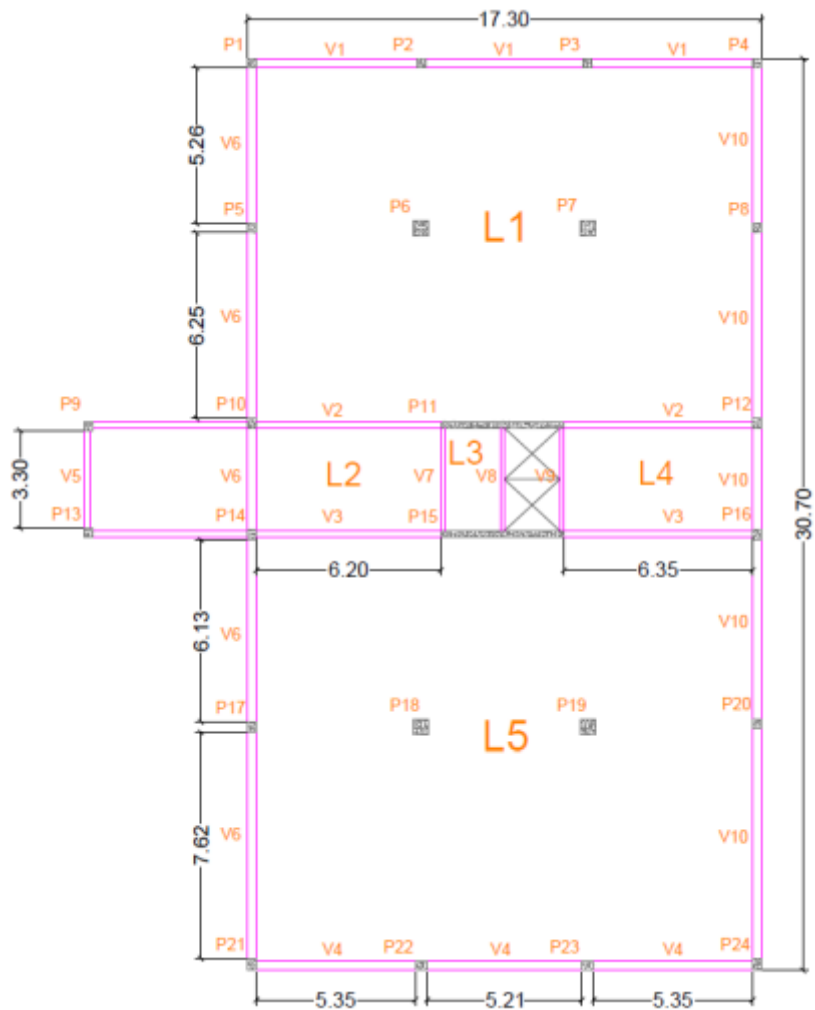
Planta de forma do pavimento tipo. (PAIVA, 2021).
